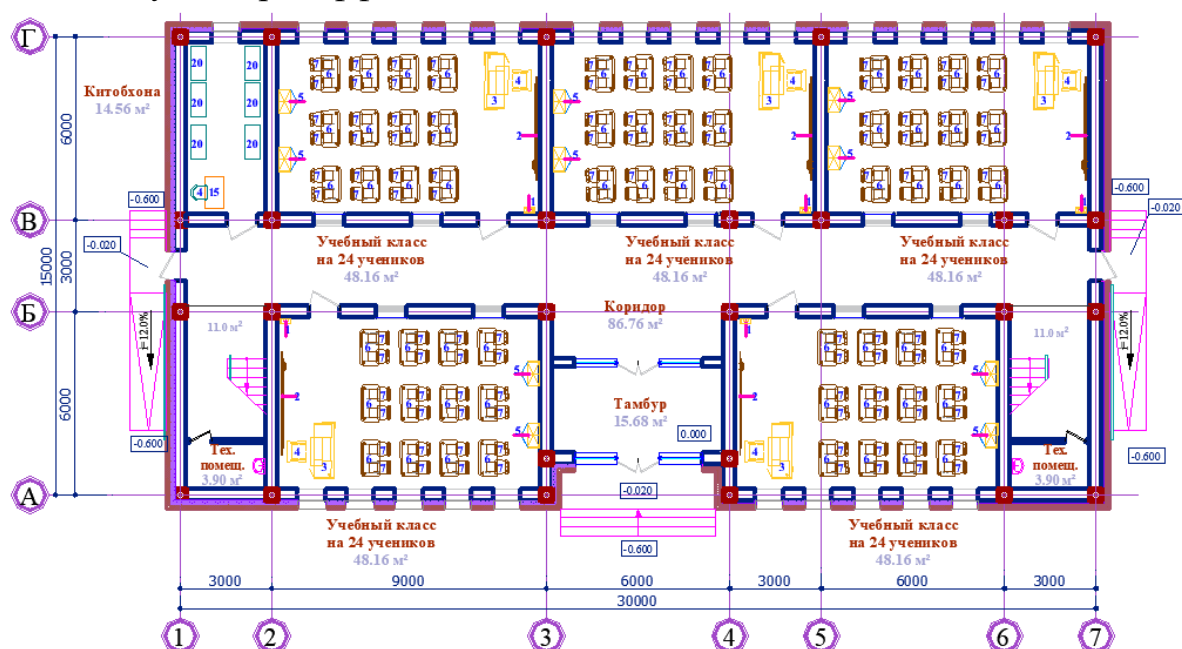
План 1-го этажа энергоэффективного здания СОУ
